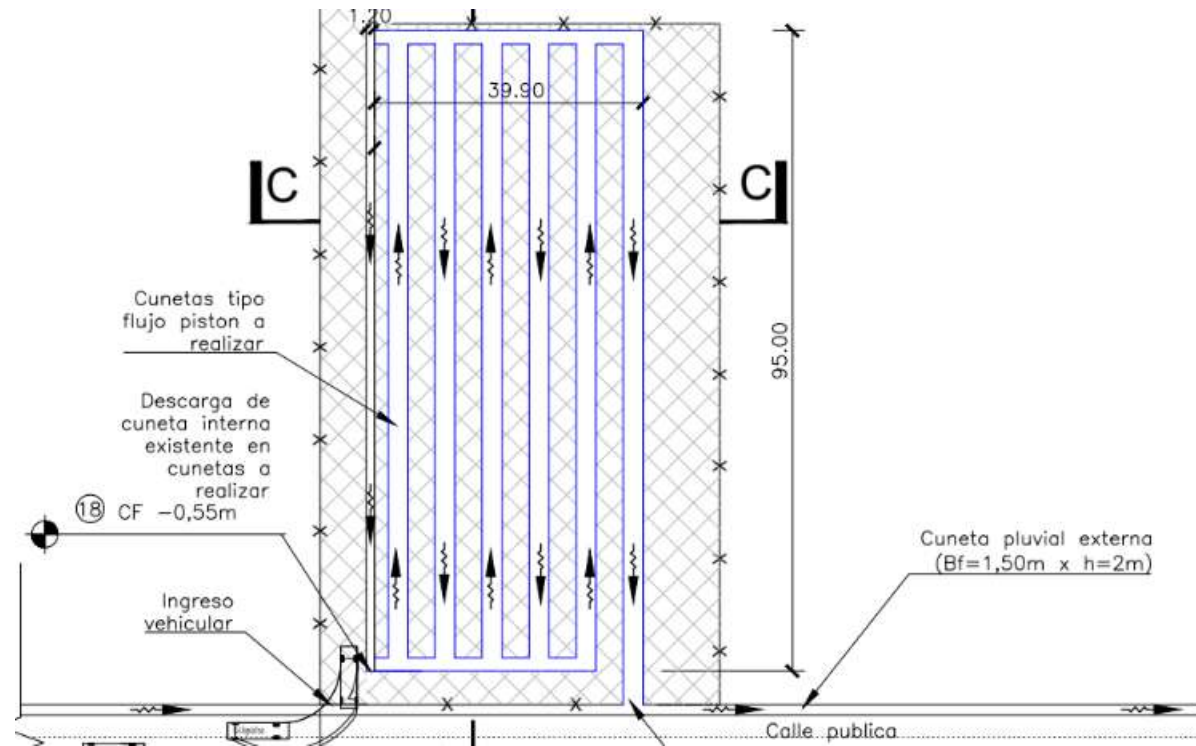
Vista en planta del sistema de tratamiento proyectado – Fuente de elaboración propia
